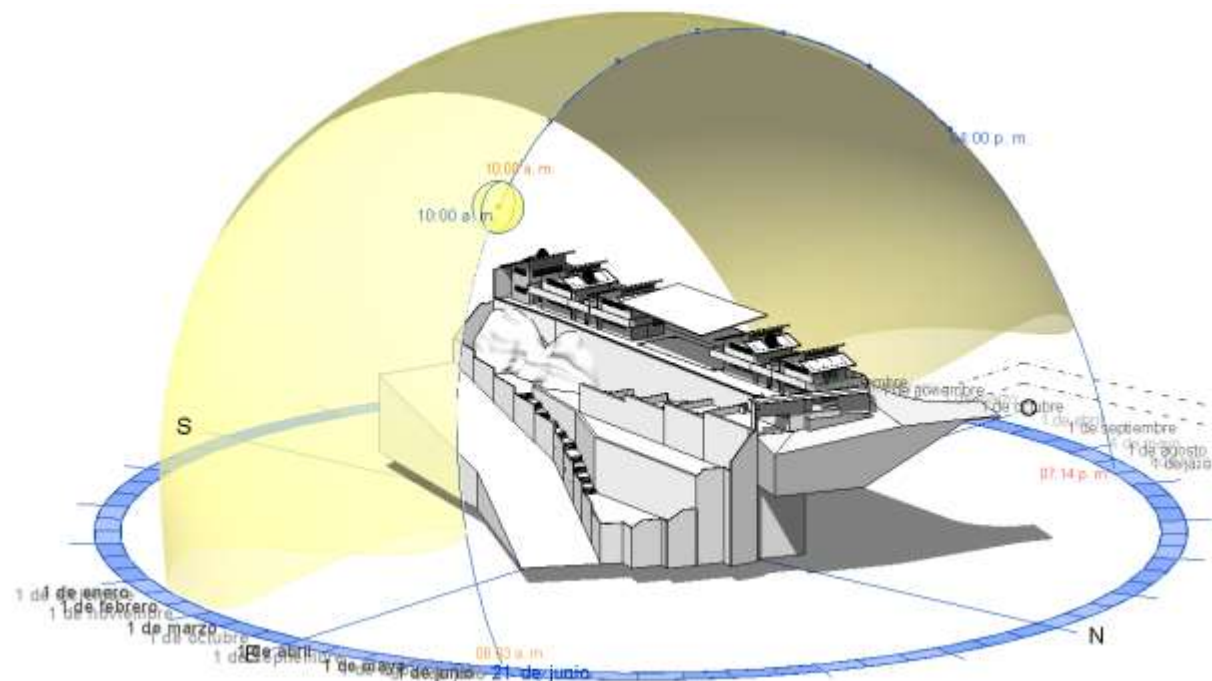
Trayectoria solar del emplazamiento vista NE. Fuente: Elaboración propia en REVIT
